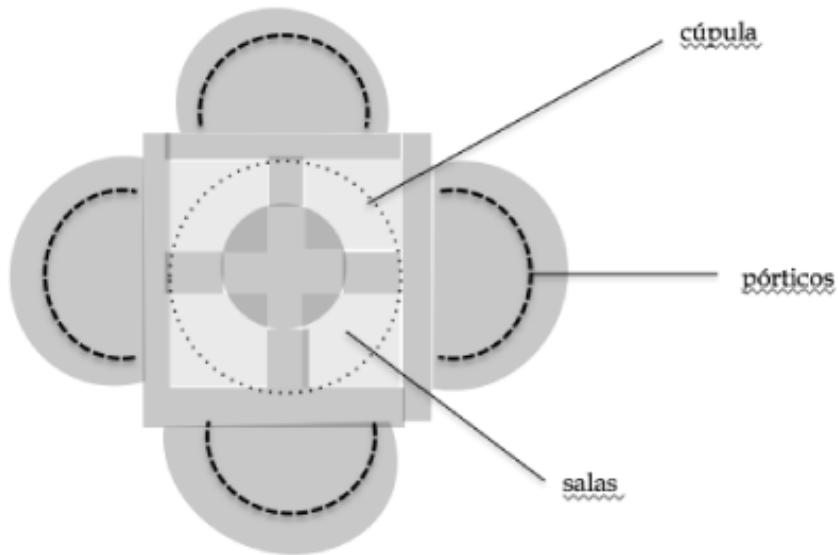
Museu do Prado, Juan Vilanueva, Madri, 1784. Provável planta original.
